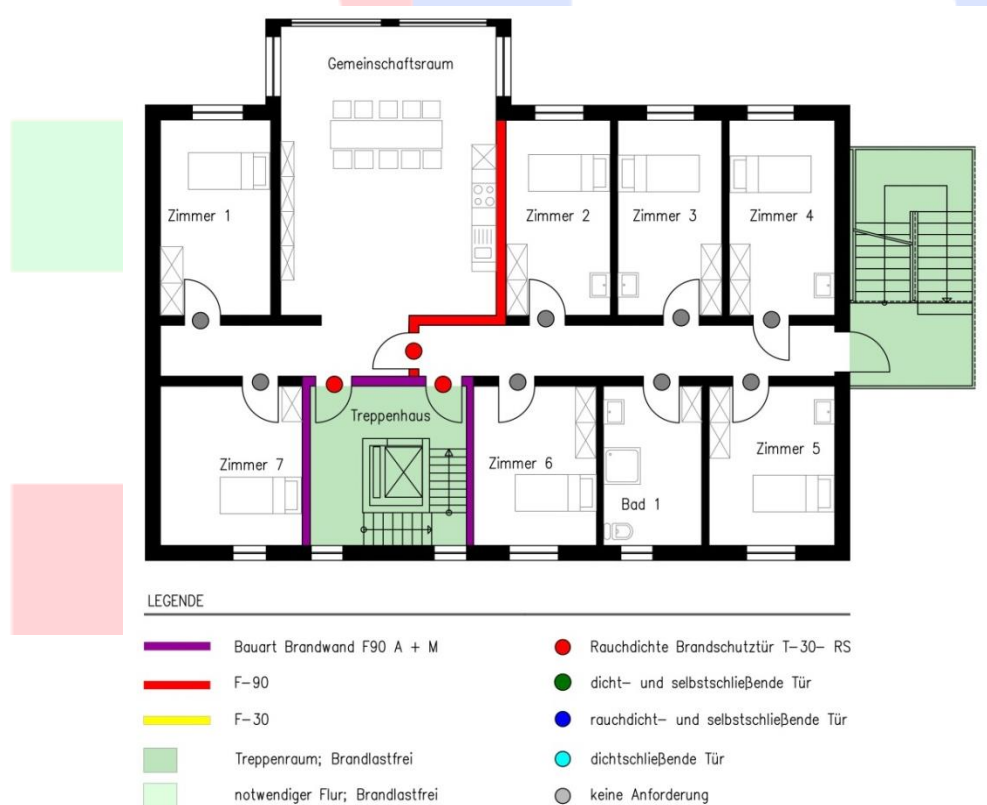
Anforderungen gemäß Bauprüfdienst Hamburg
